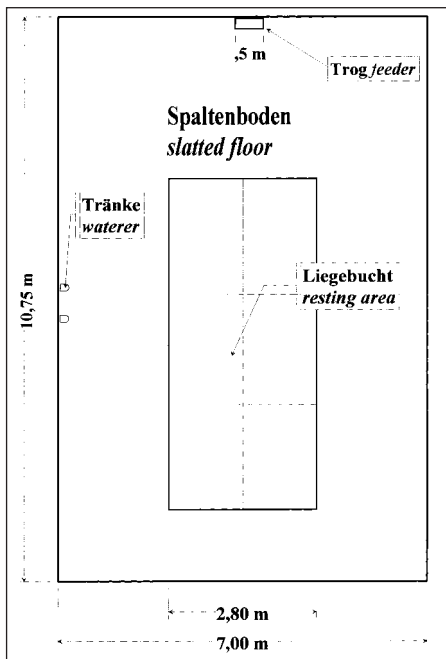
Grundriss der Gruppenbucht für tragende Sauen
